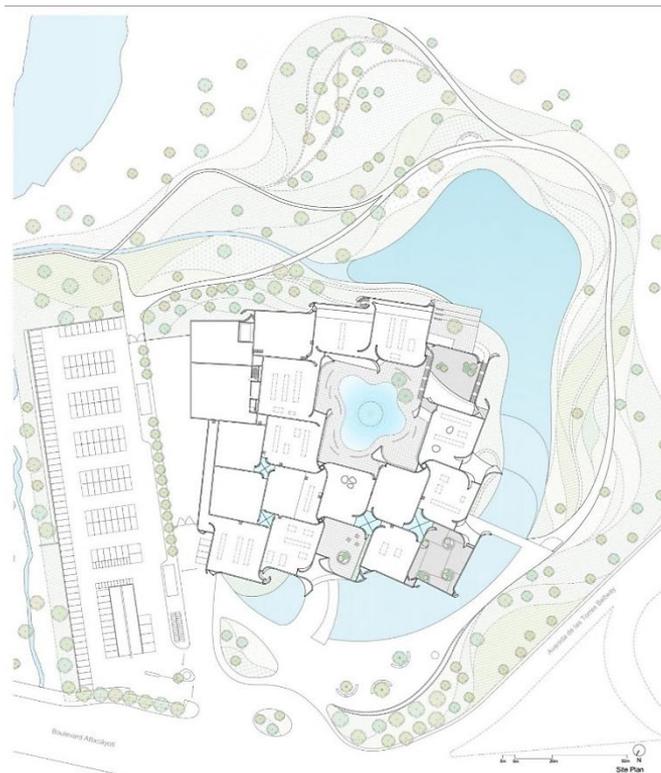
Генеральный план Фасад Международного музея барочного искусства
